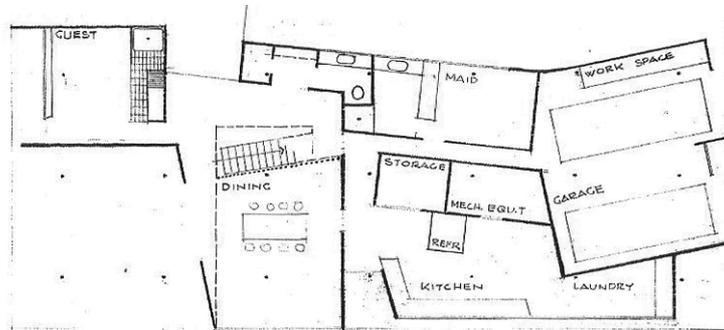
| Planta térreo Parasol House [BÜTTIKER]
